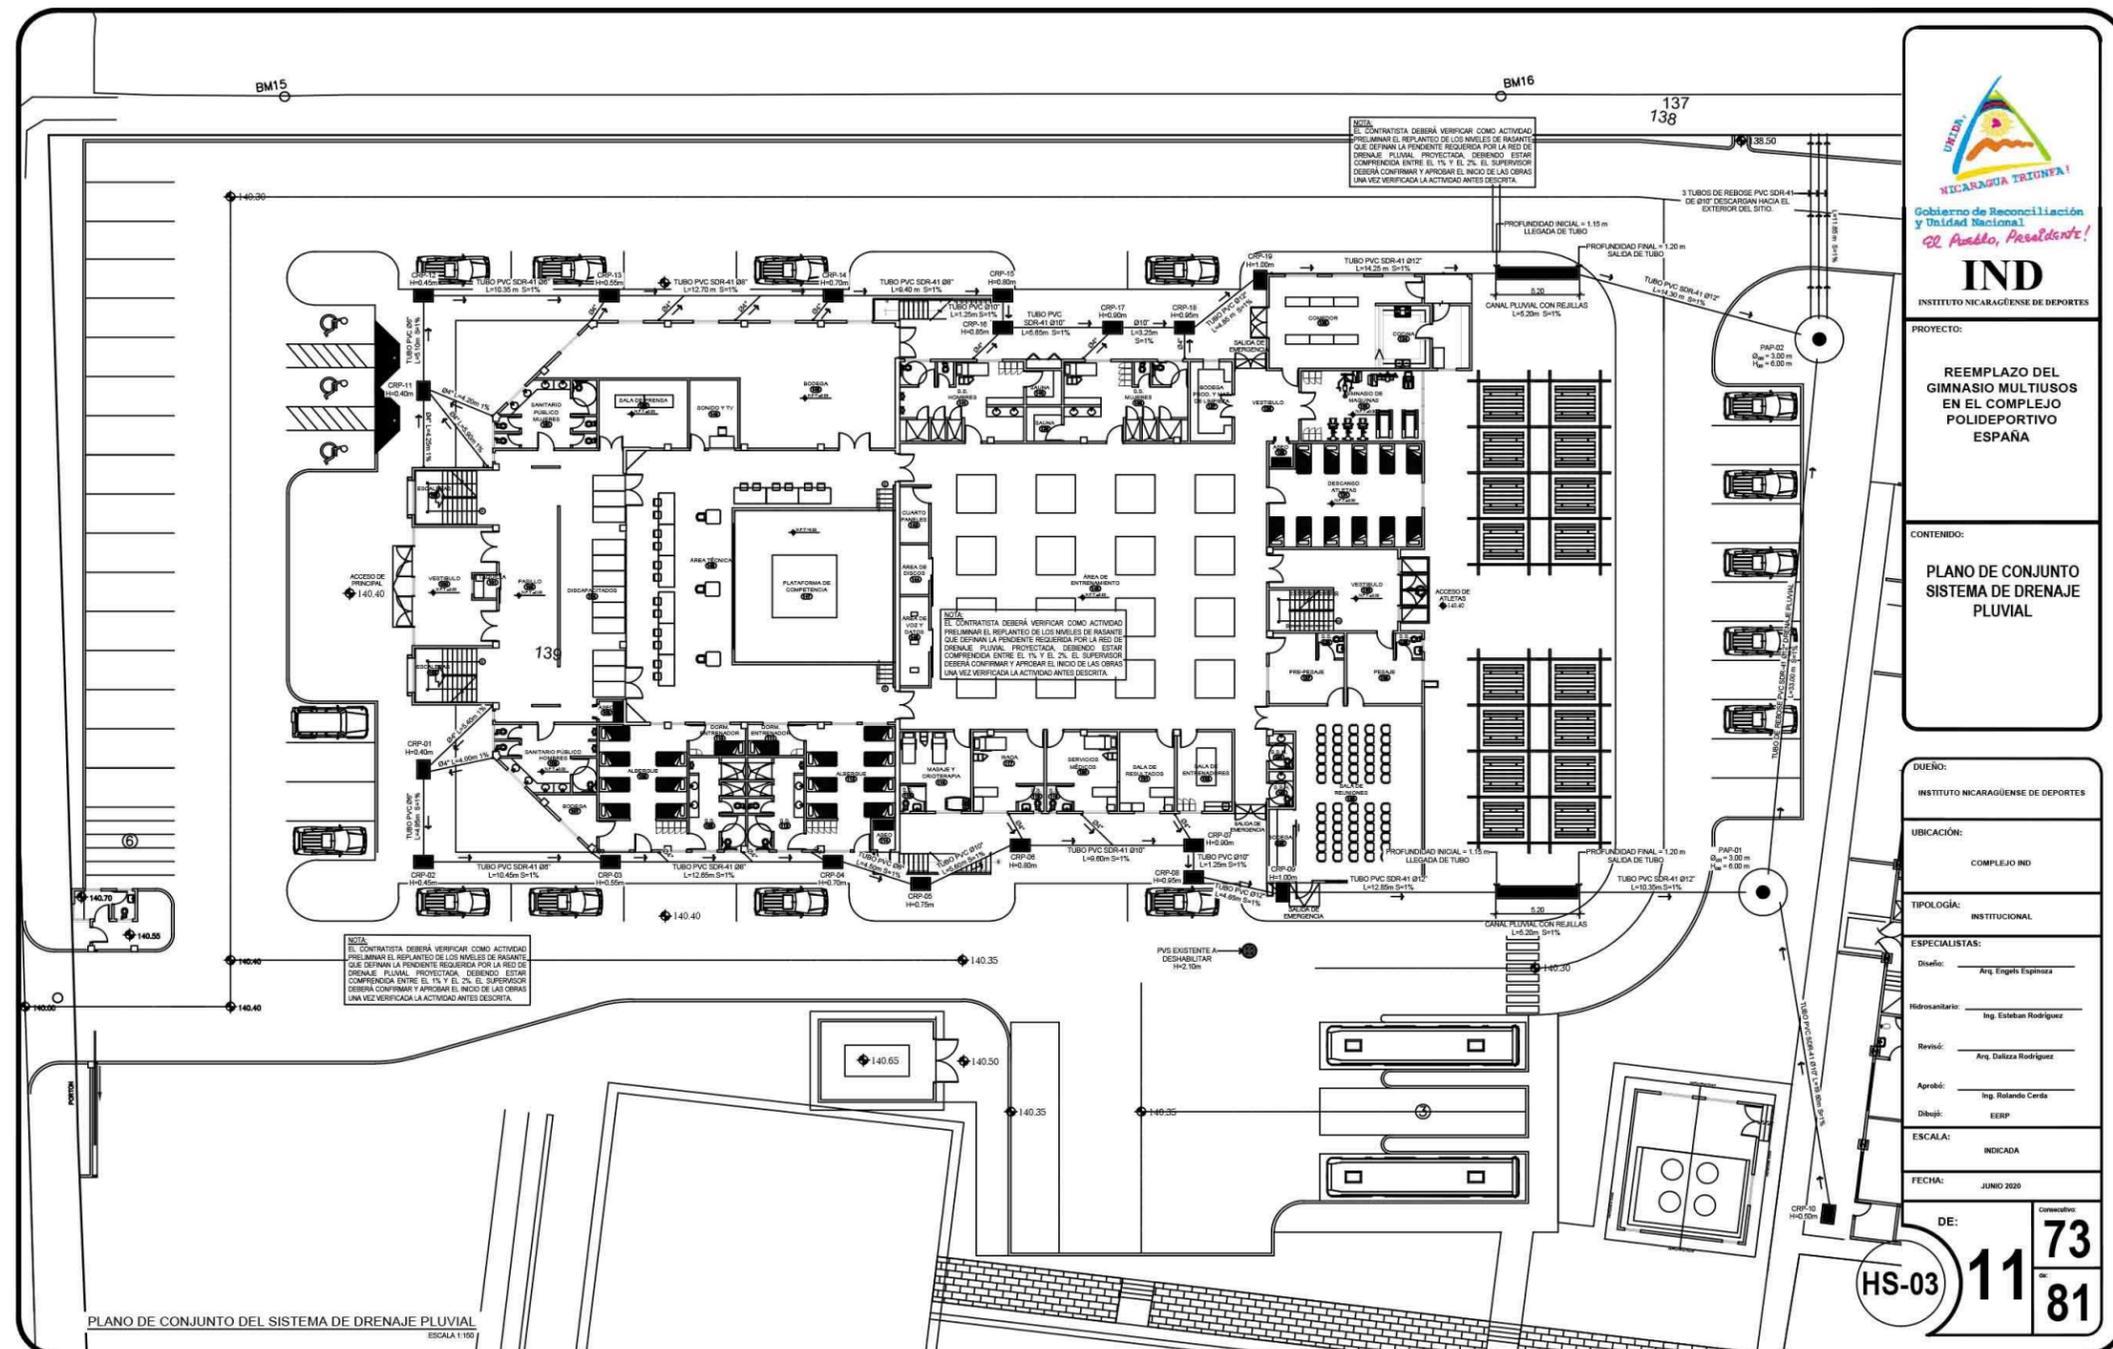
Plano de conjunto del sistema de drenaje pluvial, Modificado por la Practicante
